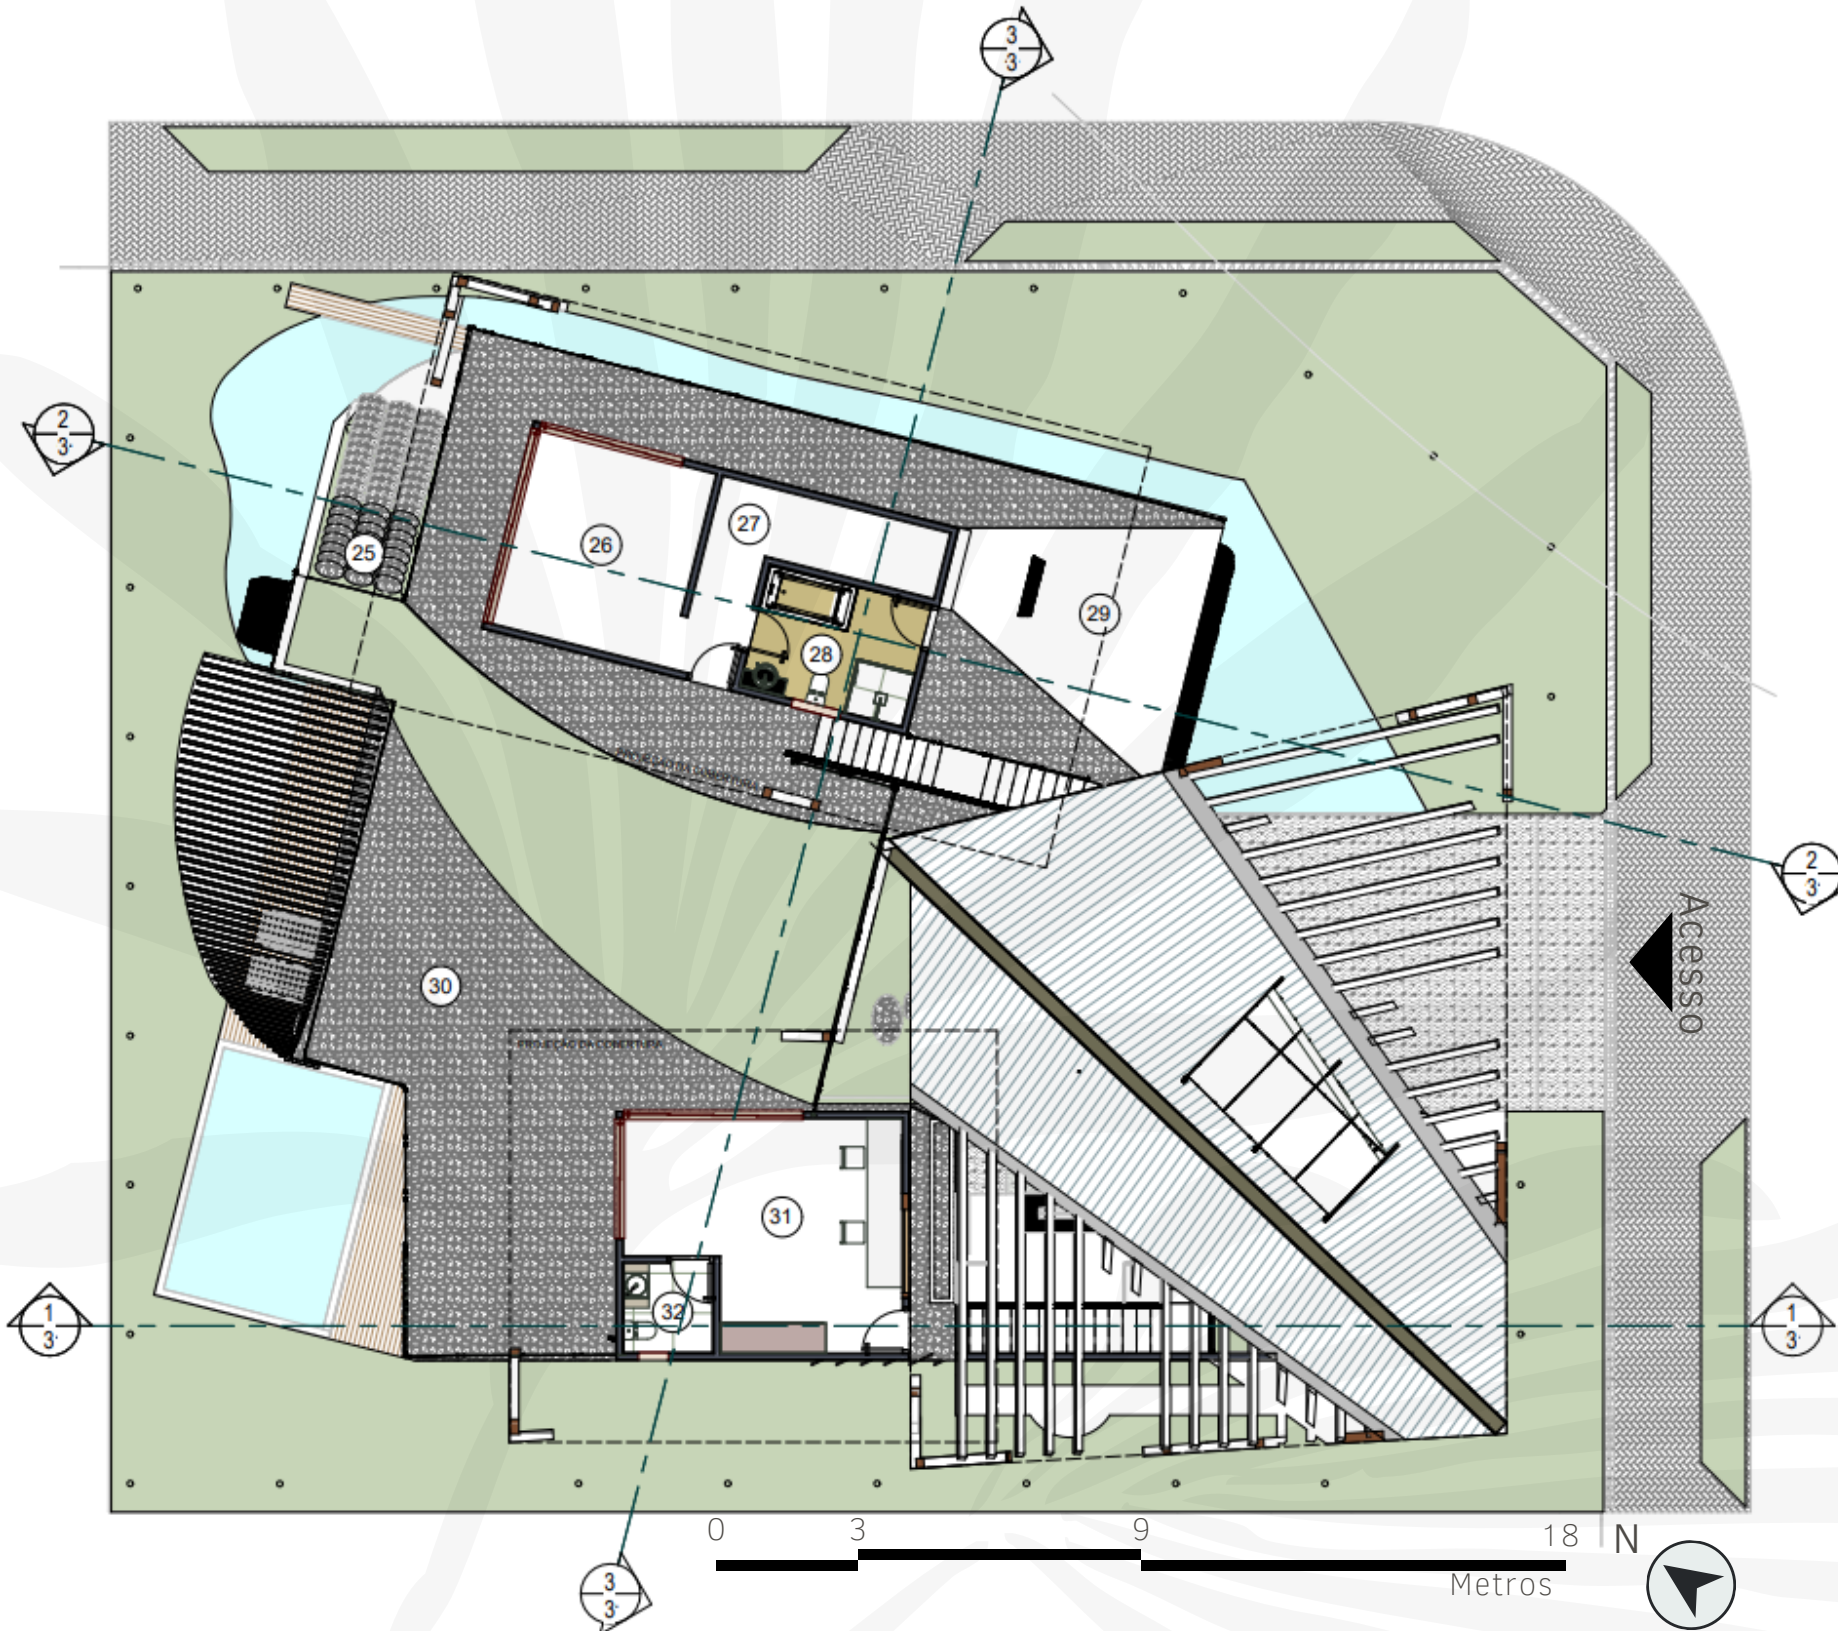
Planta Baixa - 1º Pavimento. Fonte: Elaboração própria da autora.
